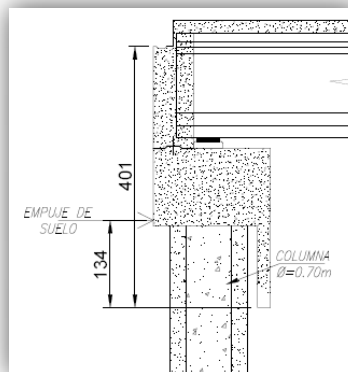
Ubicación de empuje horizontal, Estribo –Columna –Pilote
